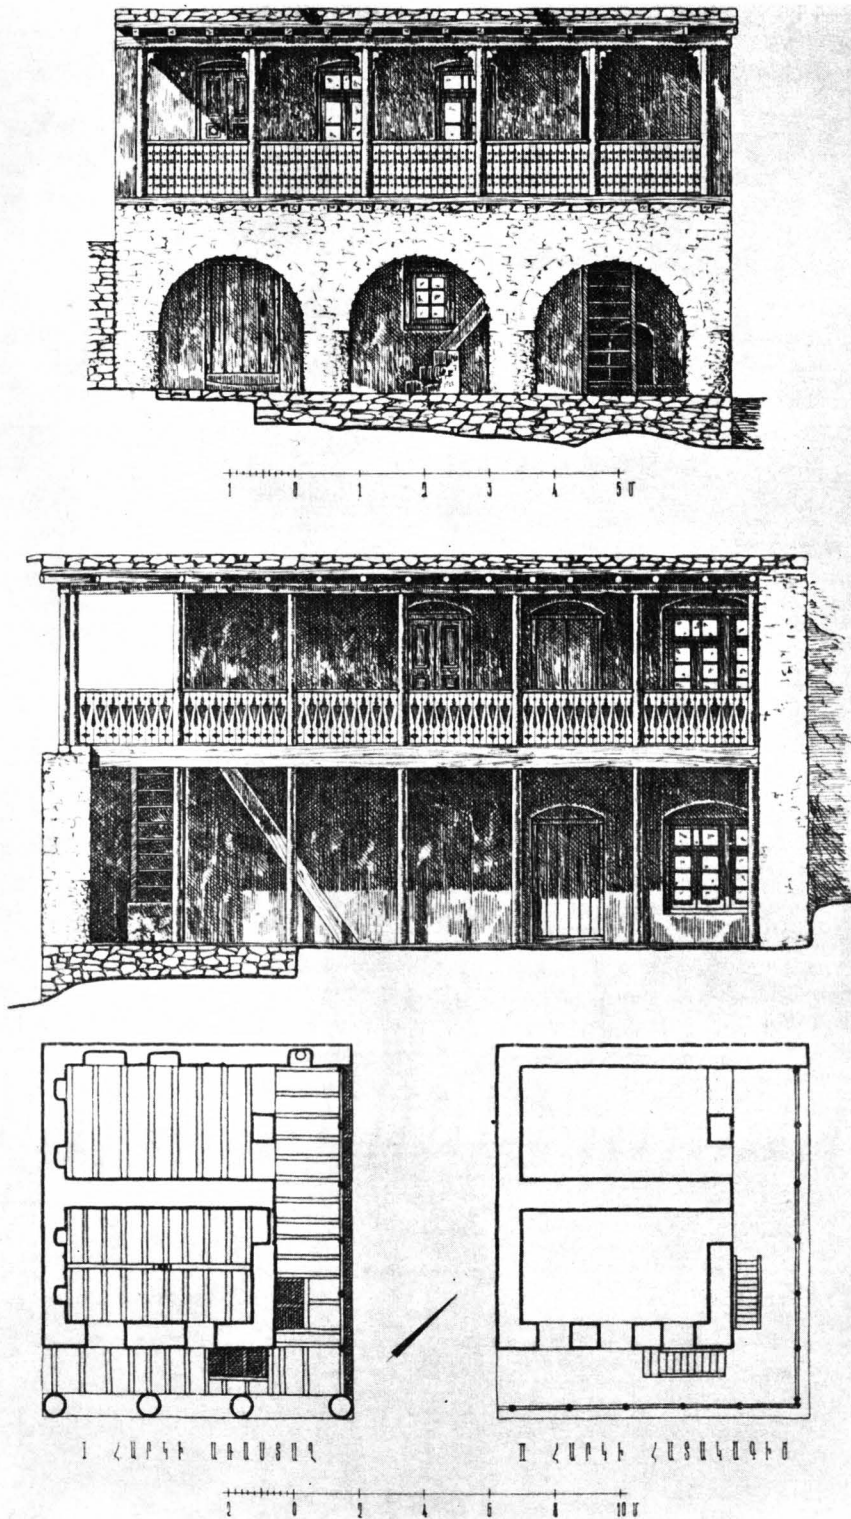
Maison d'habitation rurale de type urbain à Chevanidzor (façades principale et latérale, plafond du rez-de-chaussée et plan du 1^{er} étage).
